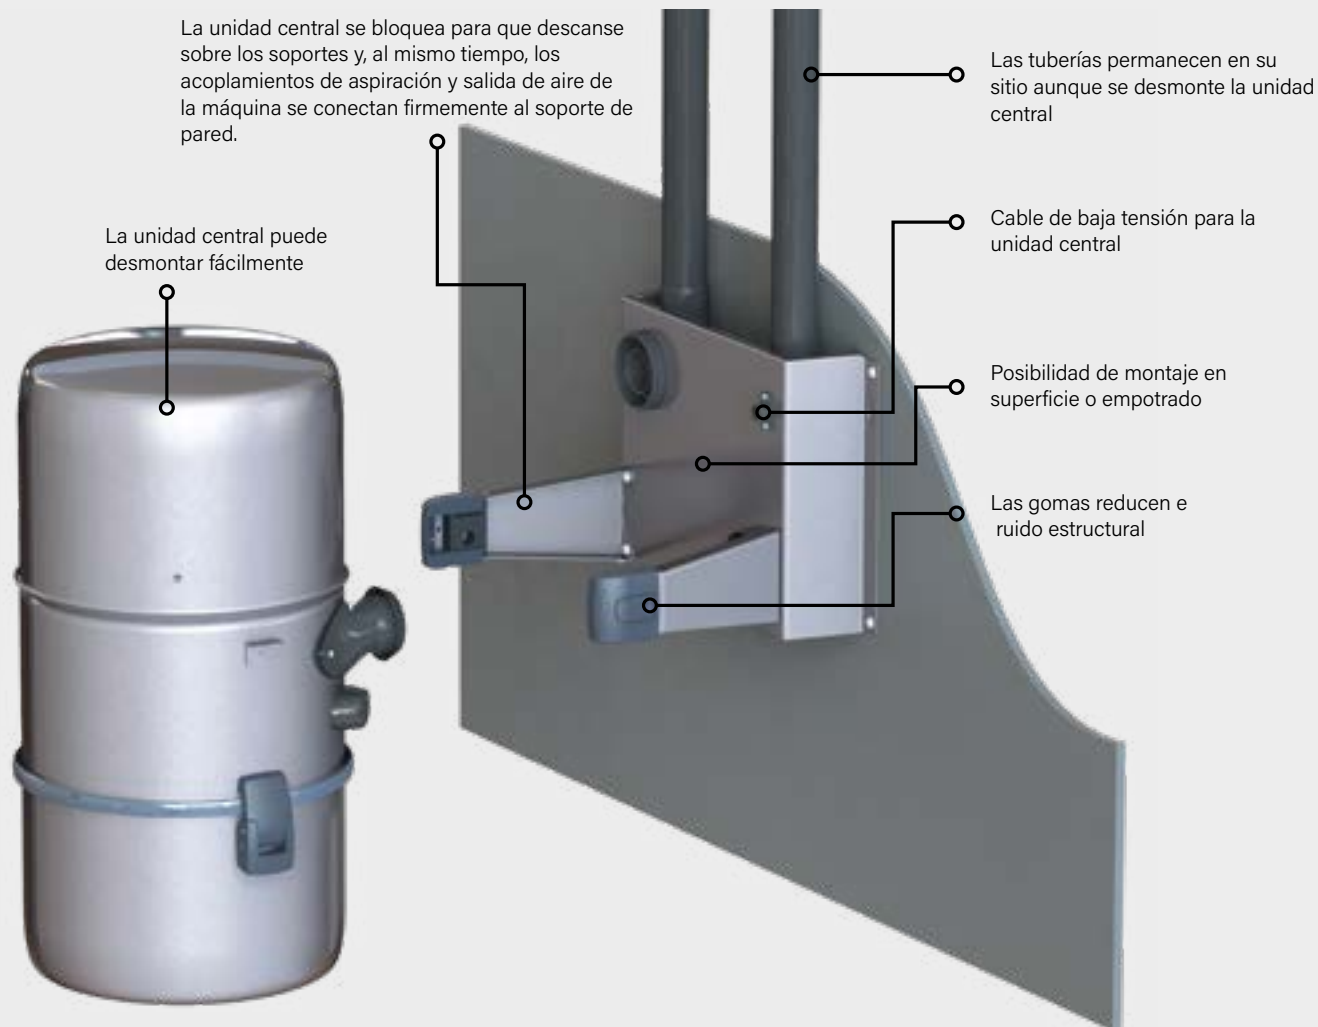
Un soporte de pared de la serie C se instala en una pared para la unidad central de la serie C. La instalación es posible en todas las estructuras de pared. Tanto la instalación empotrada como la instalación en superficie son posibles.
